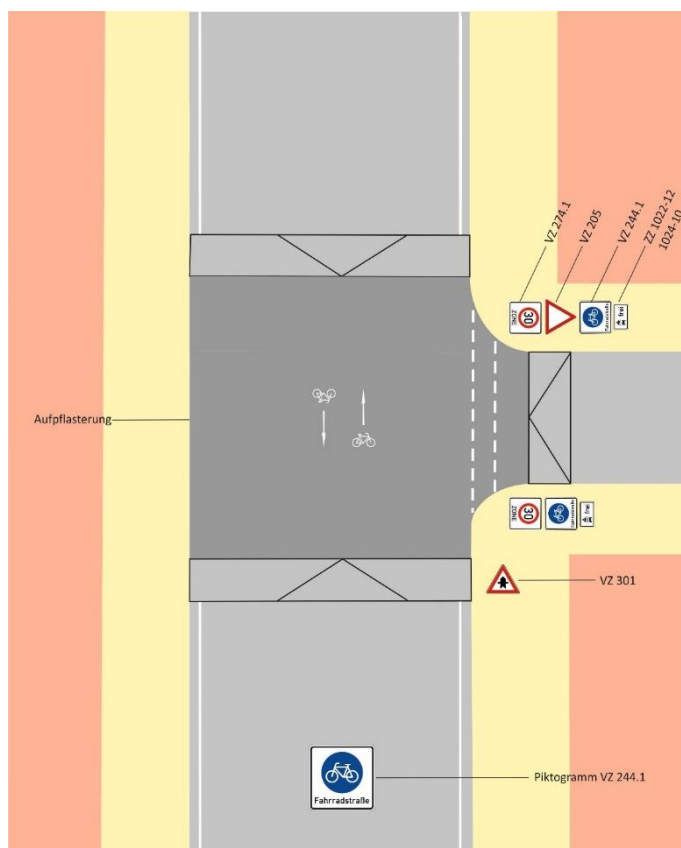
Musterfahrradstraße mit Aufpflasterung (Eigene Darstellung)
